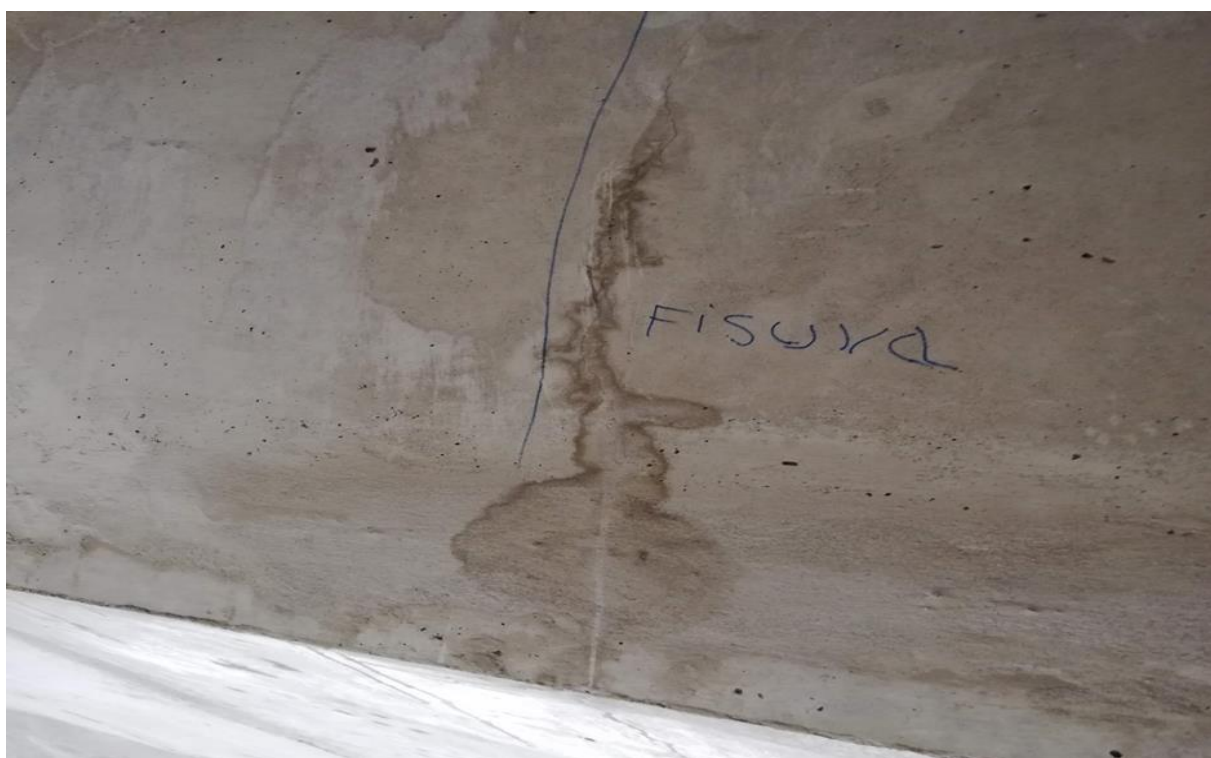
Fisura área exterior debajo del Parshall
